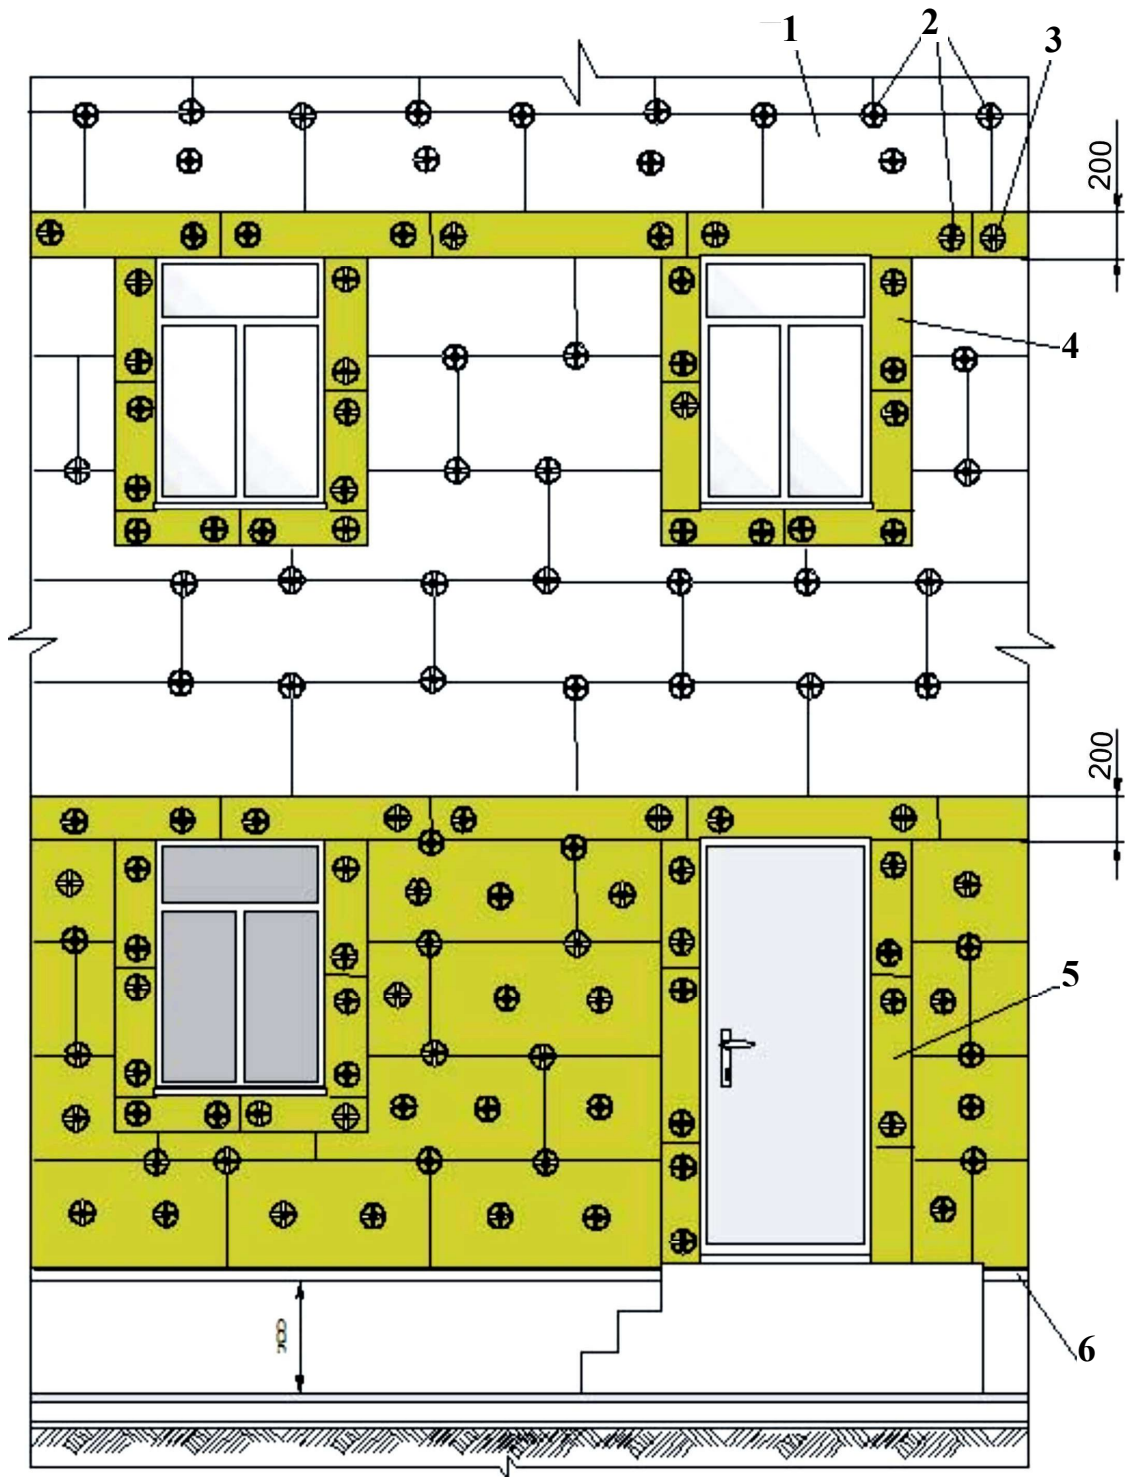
Розміщення протипожежних розтинів і нижнього пояса на ділянці фасаду будівлі: 1 – полістирольні теплоізолювальні плити; 2 – дюбелі; 3 – протипожежне розсічення з мінераловатних плит; 4 – обрамовування віконних прорізів з мінераловатних плит; 5 – мінераловатні теплоізолювальні плити утеплення першого поверху; 6 – цокольний профіль з перфорованими полицками
